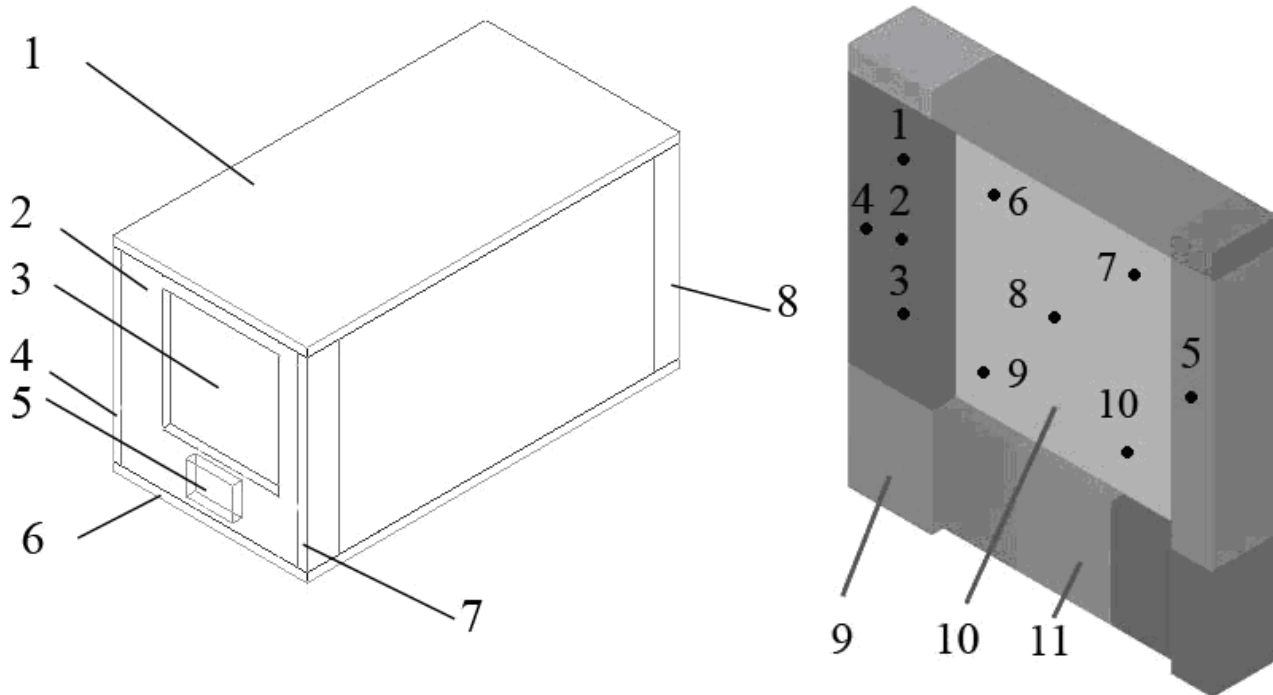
Схема исследуемого помещения (а) и наружной ограждающей конструкции (б), вид изнутри помещения: 1 – потолок, 2 – наружная стена, 3 – окно, 4 – правая боковая стена, 5 – радиатор, 6 – пол, 7 – левая боковая стена, 8 – внутренняя стена; 9 – наружная стена, 10 – окно, 11 – радиаторный участок наружной стены, точки 1-10 точки измерения температур.
